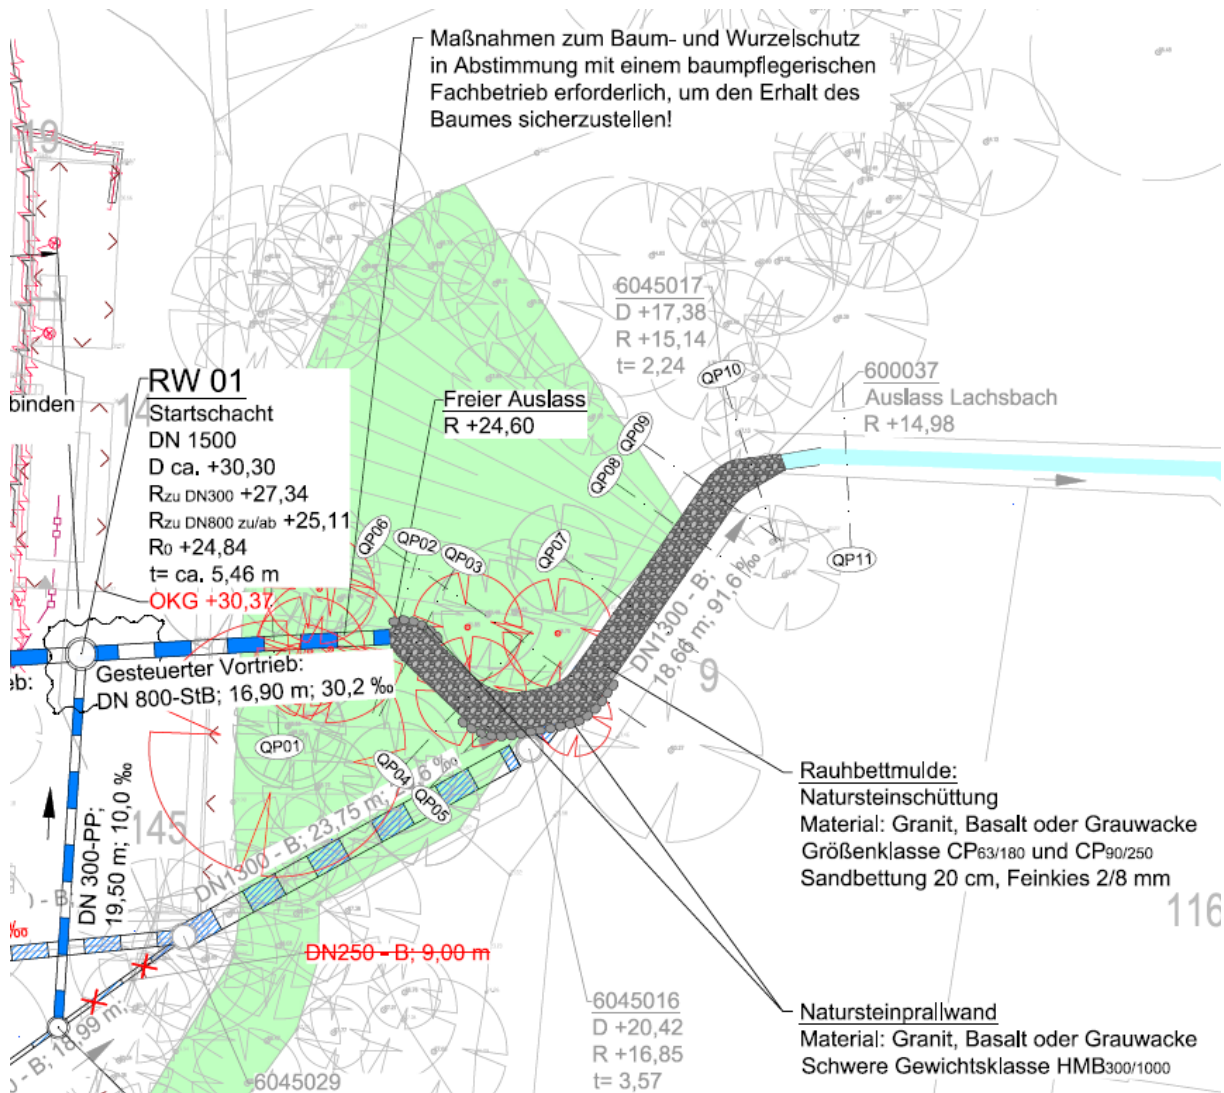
Ausschnitt Lageplan der Vorzugsvariante (Masuch + Olbrisch 2025b)
